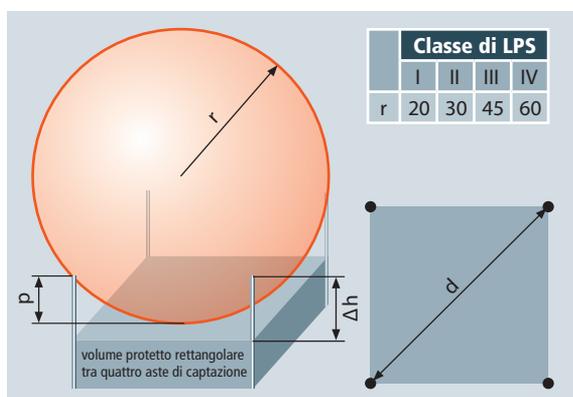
Impianto di captazione per strutture sul tetto e volume protetto
